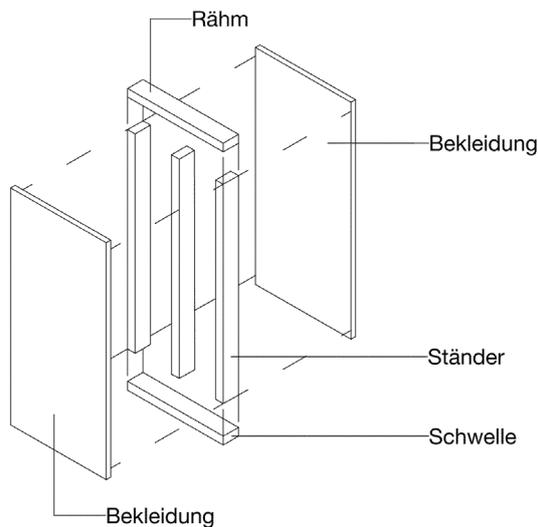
Aufbau einer Holzrahmenbauwand (Eigene Darstellung)
